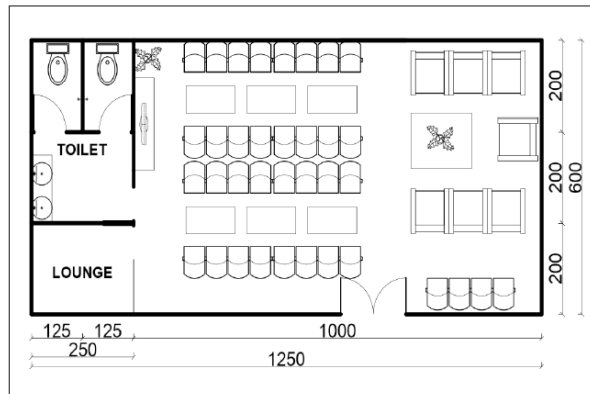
24 Tipikal Denah Ruang Istirahat Kru KA
